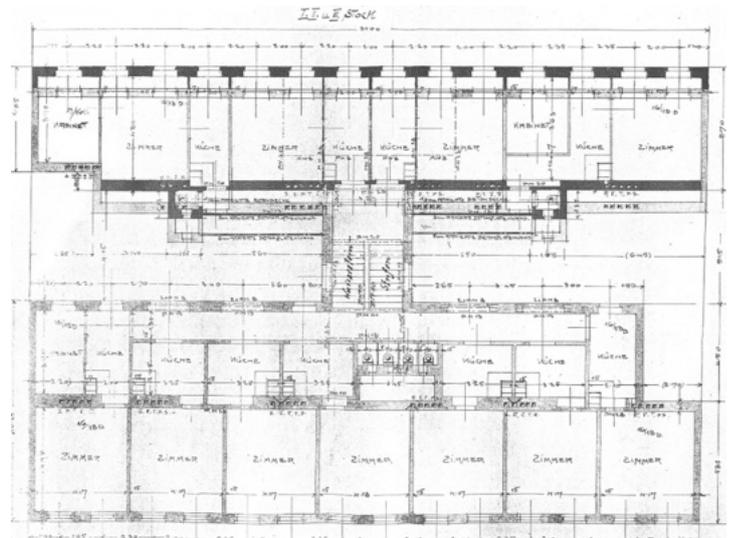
H-Form Grundrissstyp der Hochgründerzeit (rechts)⁵⁴
